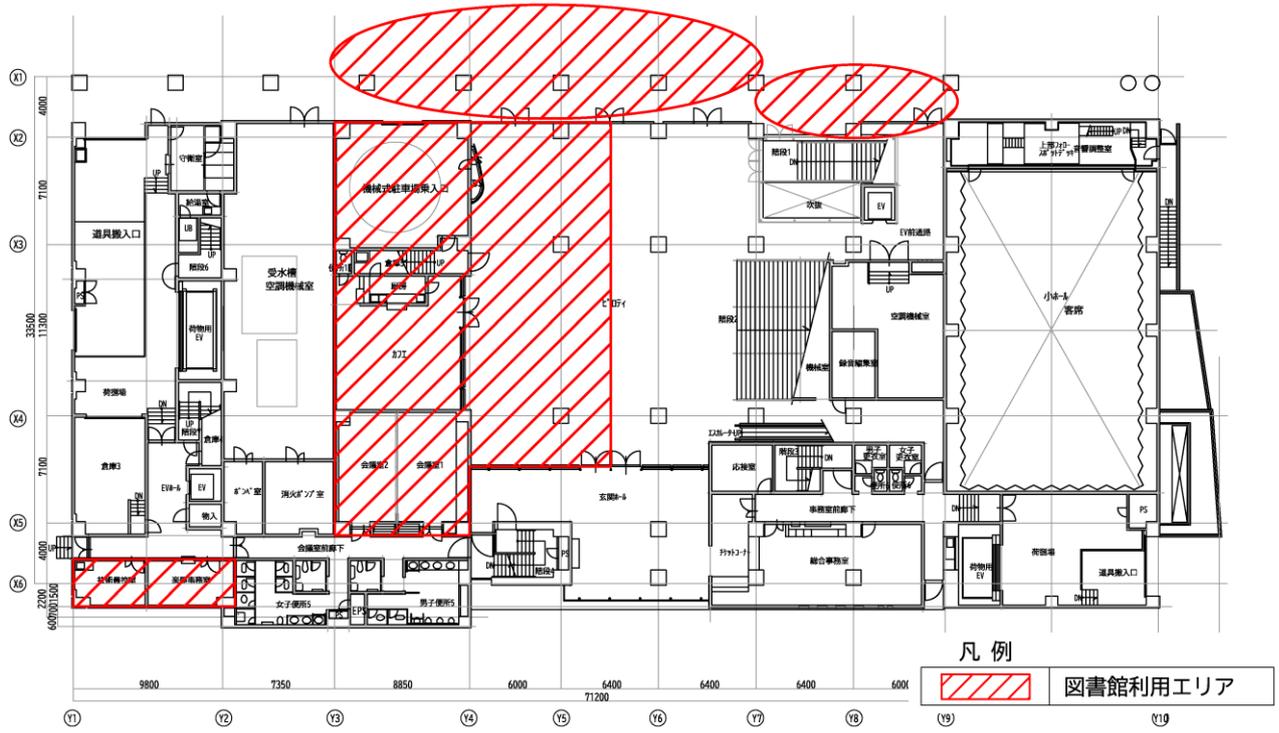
市民文化会館（リビエールホール）機能位置図（案） 1階平面図
